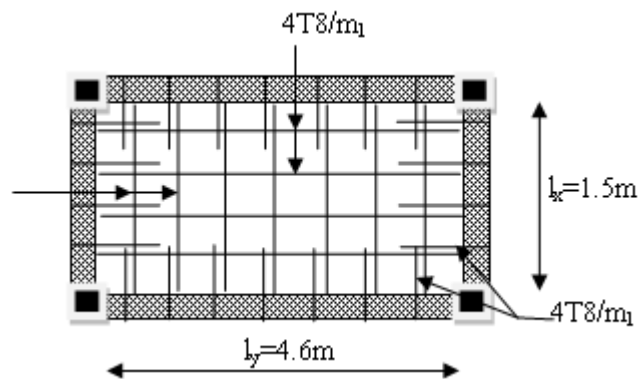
Schéma de ferrailage du panneau de dalle D4
